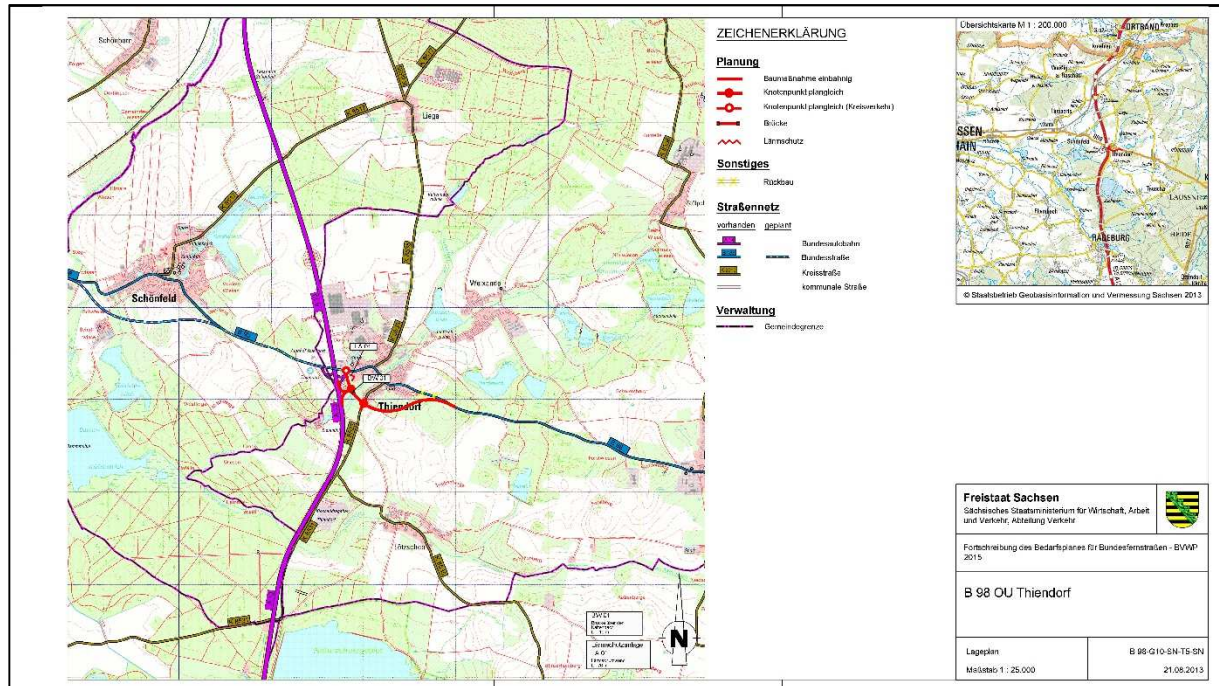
Bundesverkehrswegeplan 2030 – Auszug Lageplan B 98 OU Thiendorf
